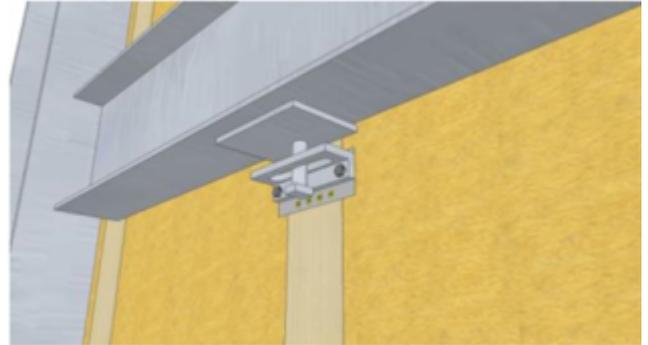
Fixation définitive sur ouvrage structural intermédiaire
